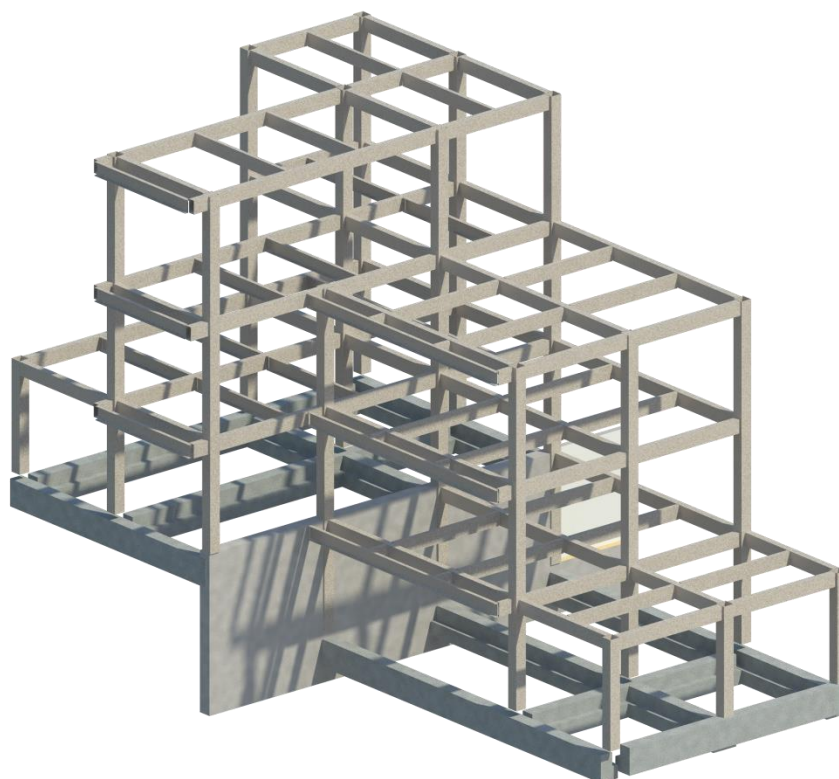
Axonometría sistema constructivo. Fuente: Propia
